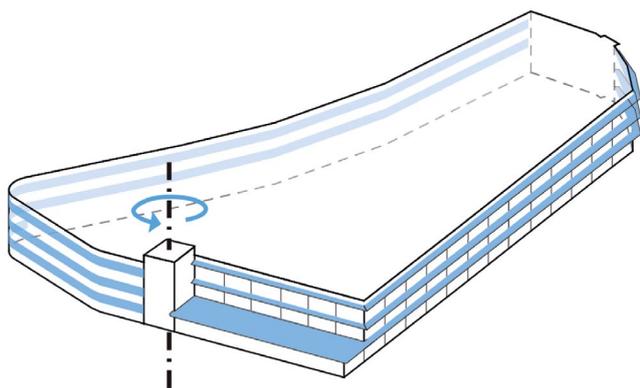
Elemento torre, de carácter vertical, que articula las dos fachadas marcadamente horizontales.
